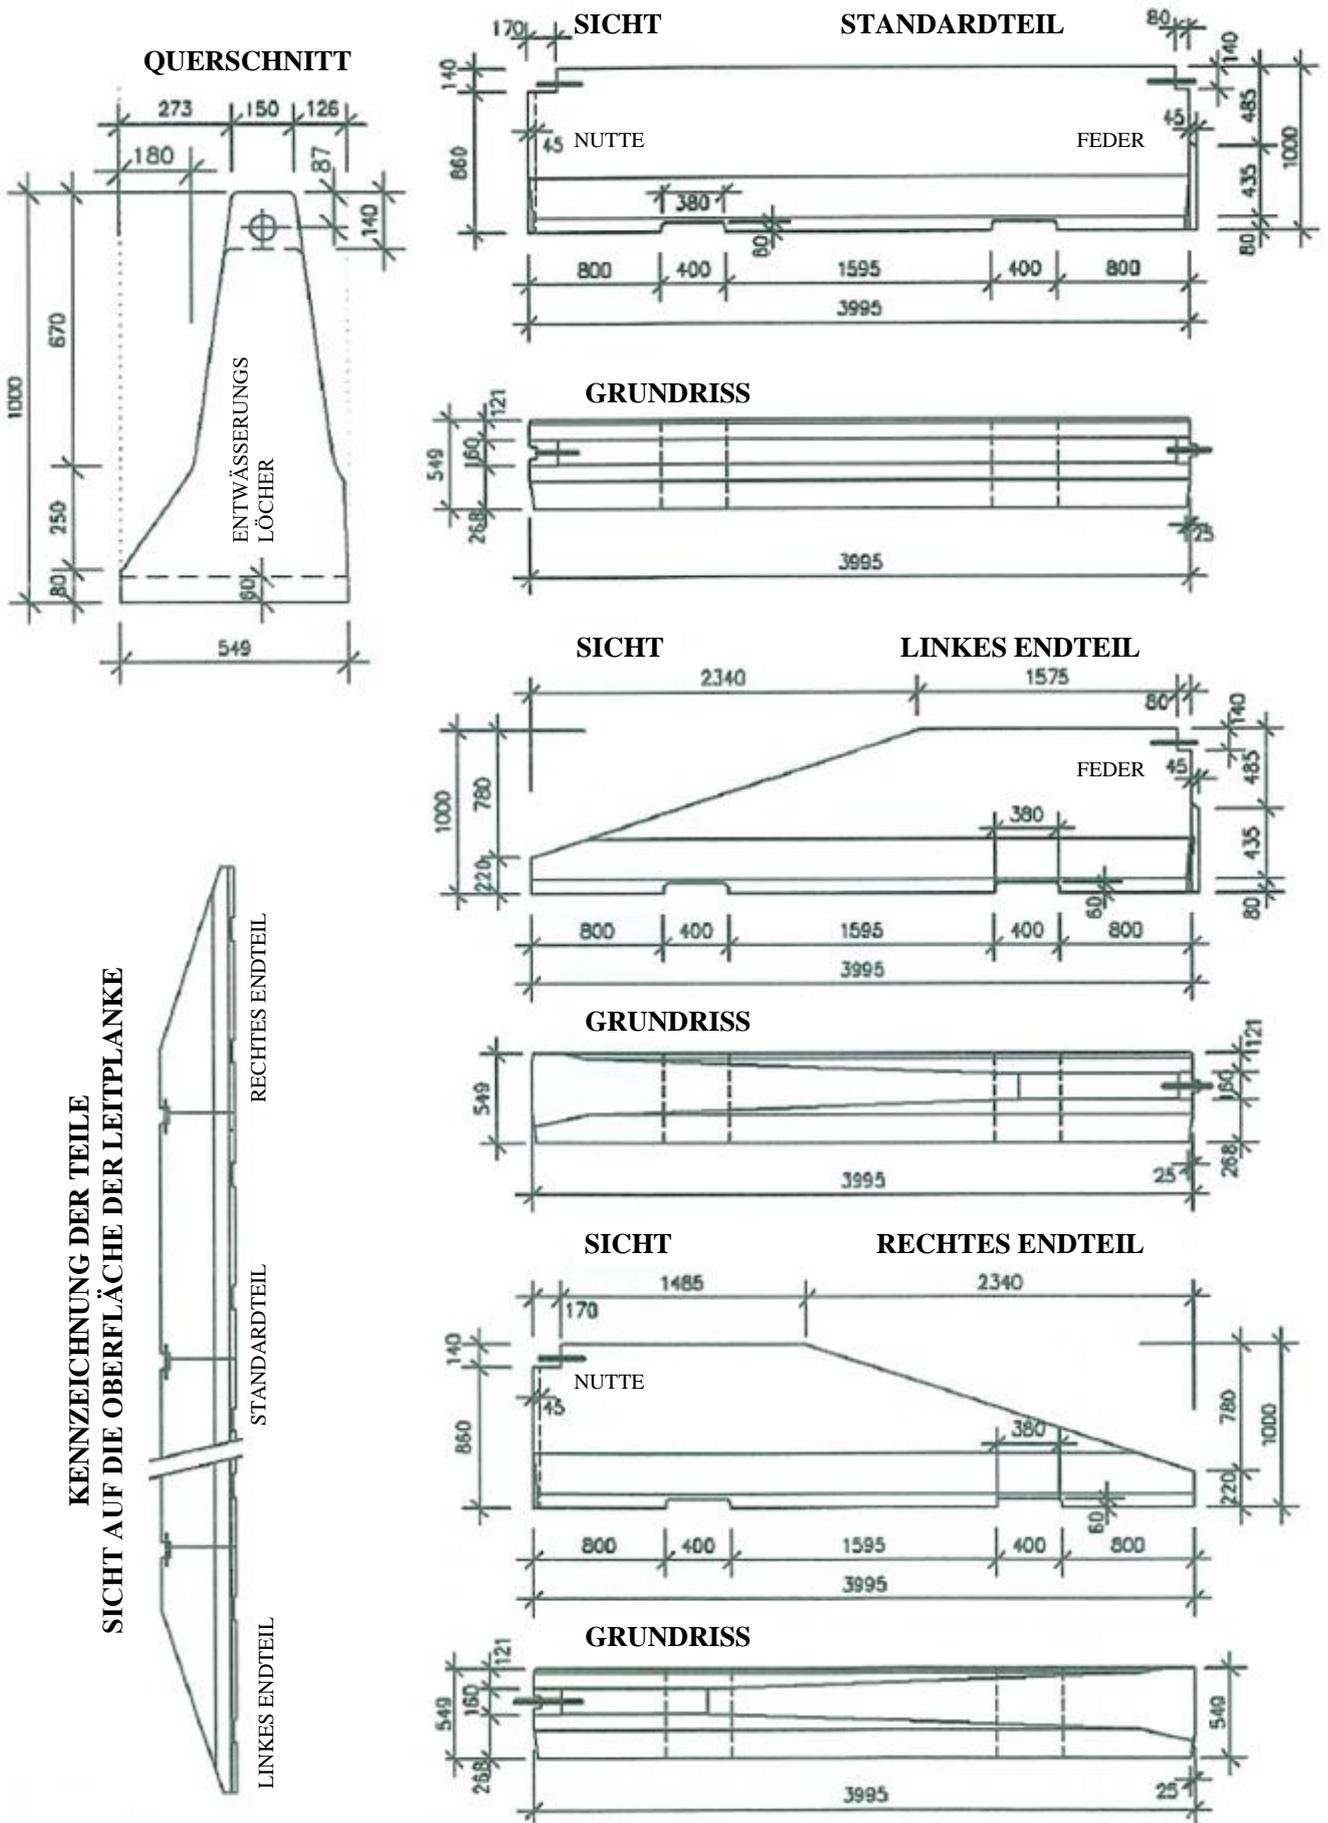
einseitige Betonleitplanke 1 m hoch - Standard- und Endteil
